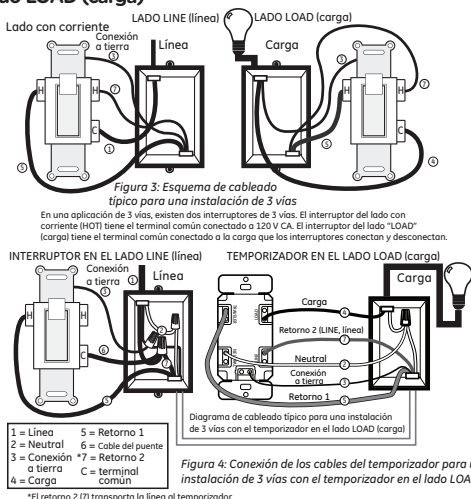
Conexión de los cables del temporizador para una instalación de 3 vías con el temporizador en el lado LOAD (carga)
